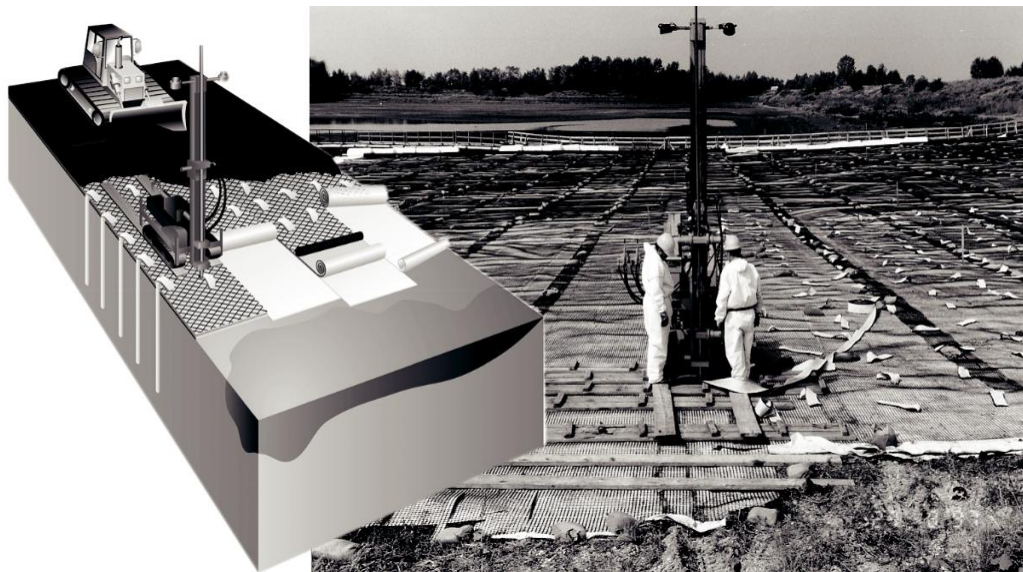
Укладання багат шарового ґрунтового покриття на відвал пустої породи
